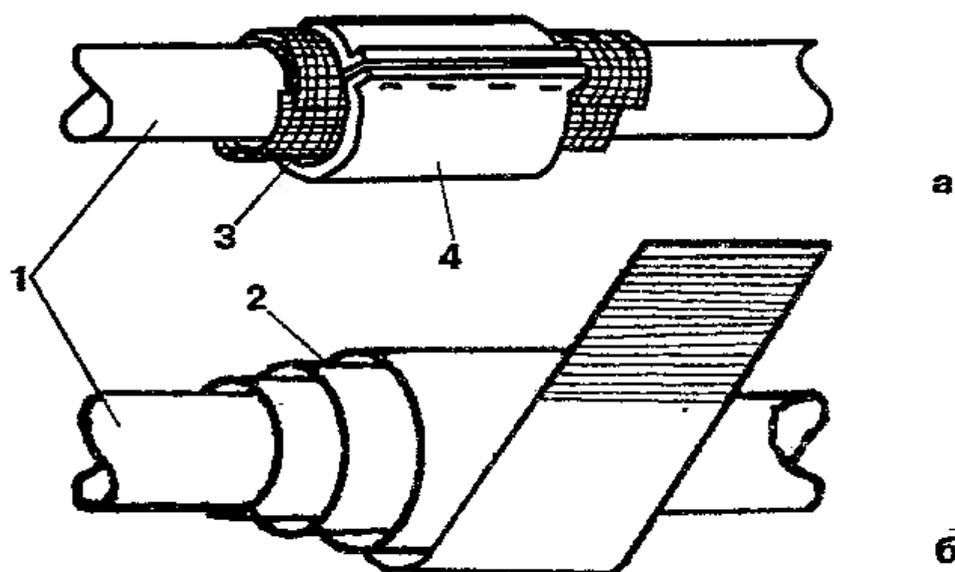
Ремонт трубопроводов: а — бандаж с листовой резиной; б — клеевой бандаж (стеклоткань); 1 — труба; 2 — стеклоткань; 3 — резина листовая; 4 — металлический бандаж
